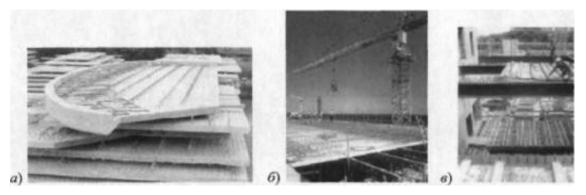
Сборно-монолитные перекрытия с несъемной опалубкой, а – плиты несъемной опалубки, б — общий вид армирования перекрытия, в – установка плит
